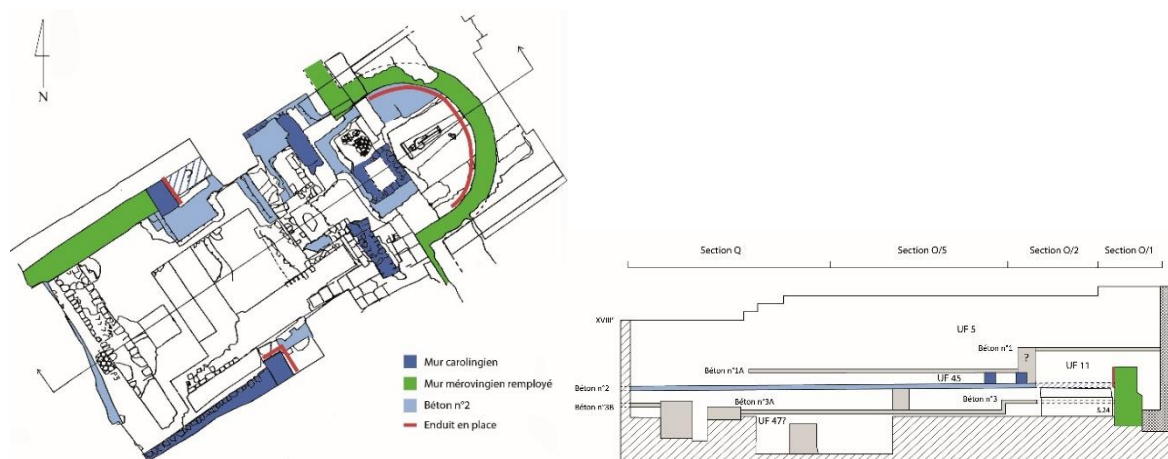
Vestiges de la seconde église du haut Moyen Âge (carolingienne), vue en plan et coupe (sections O et Q)
